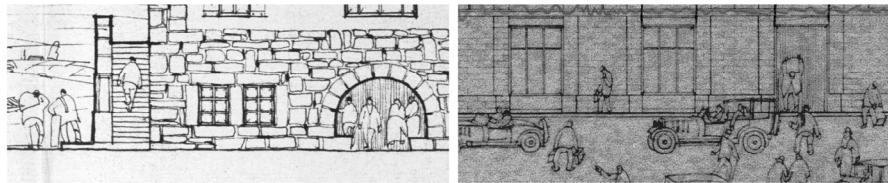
Detalles de alzados de las estaciones de Uxes y de La Coruña. FUENTE: AGA, Ferrocarriles, cajas 26/20906 y 26/20918.
